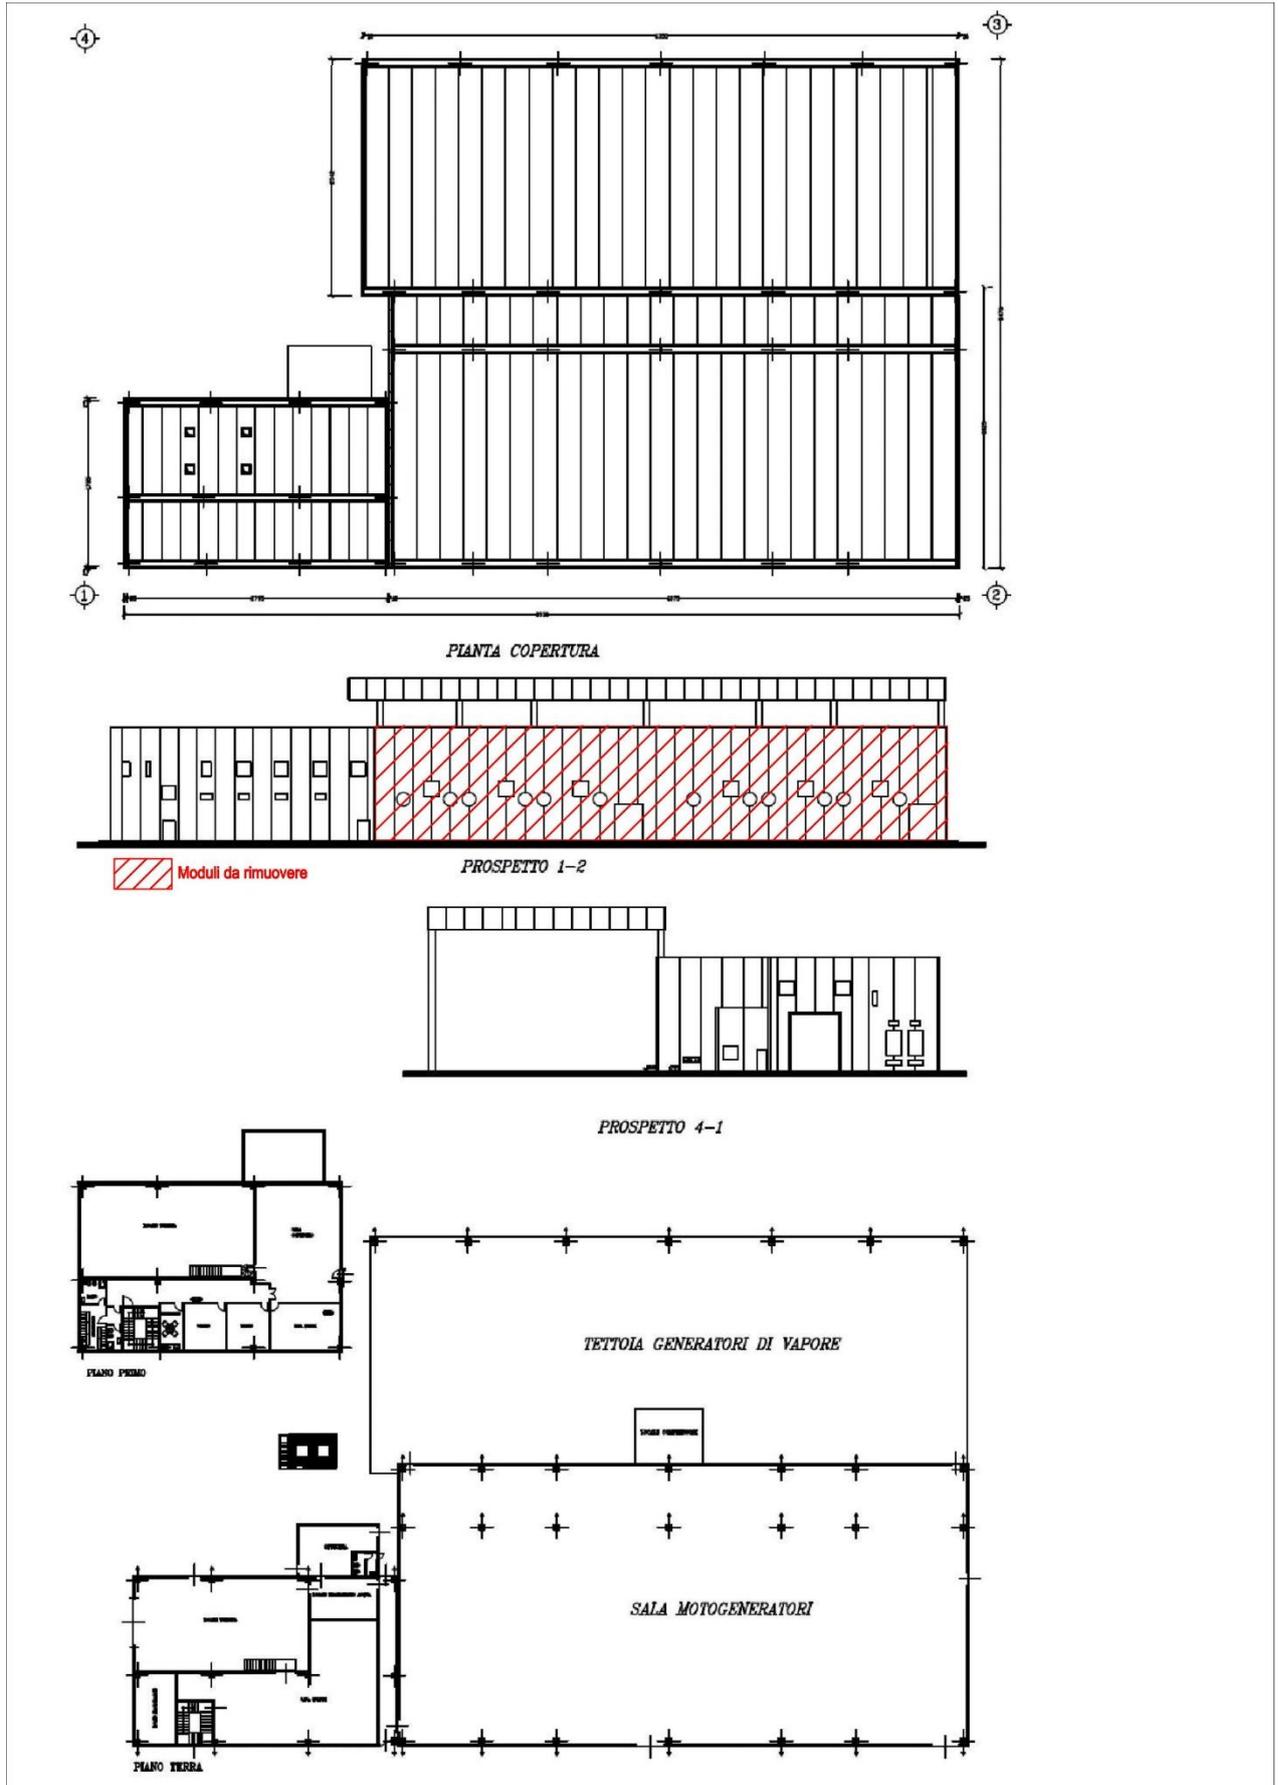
Pianta e sezioni dell'edificio in cui è installato l'impianto BL2
